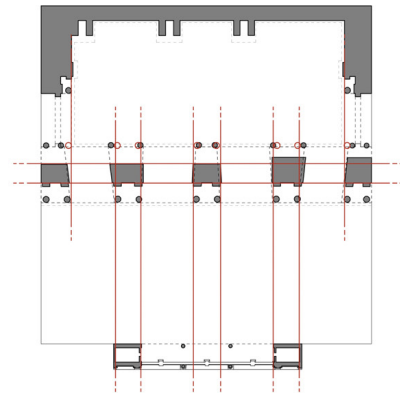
Confronto tra la pianta restituita e la pianta ricostruita filologicamente, elaborata sulla base delle ipotesi relative alla logica spaziale sottesa al progetto prospettico dell'artista (elaborazione grafica delle autrici).
